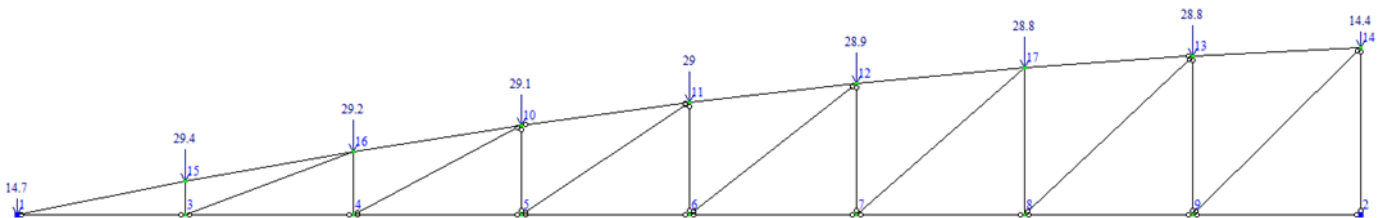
Розрахункова схема другого варіанту ферми (навантаження в кН).
